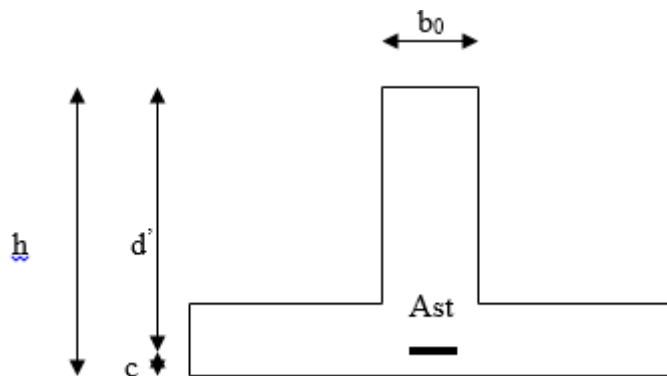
Section de calcul de la poutrelle après Coulage de la dalle de compression (Section en T)
